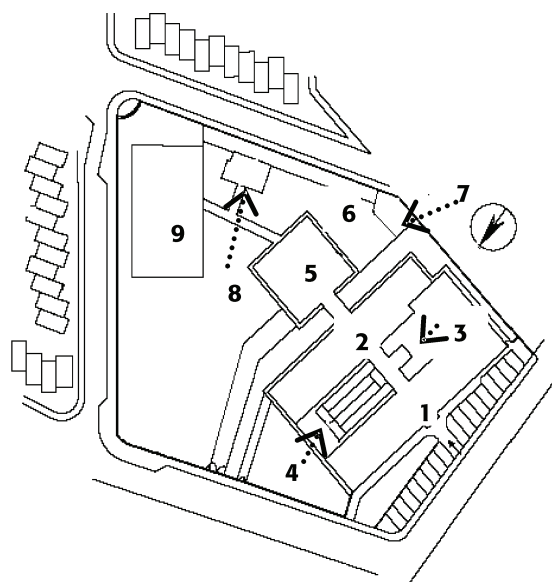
Croqui da planta baixa da Escola Básica Donícia Maria da Costa
